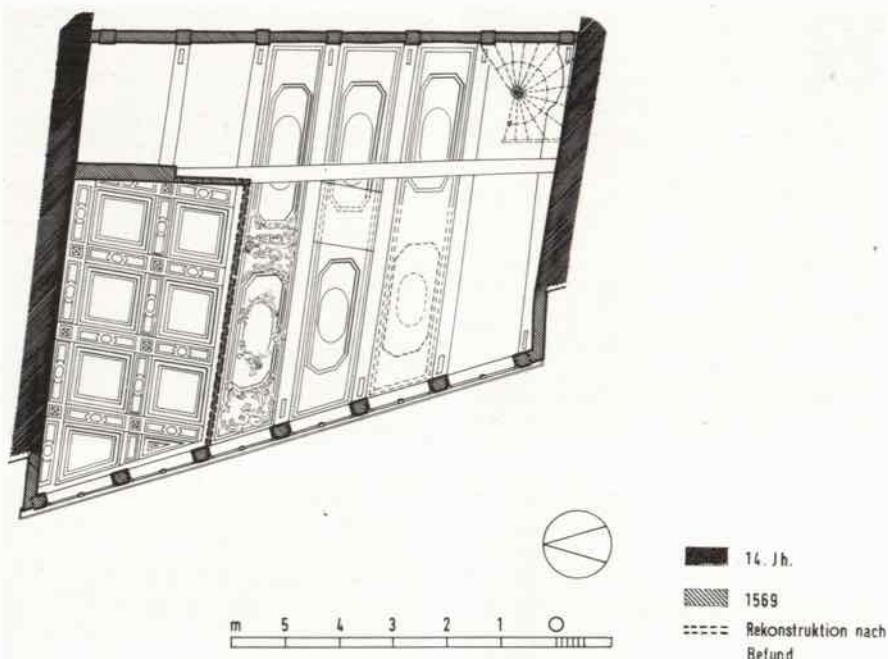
An der Untertrave 96 – Grundriß 1. Obergeschoß; Bauzustände bis 1700 mit Projektion der Deckenausstattung – Dornse Kassettendecke um 1600, Diele mit Landschaftsmalerei um 1680
